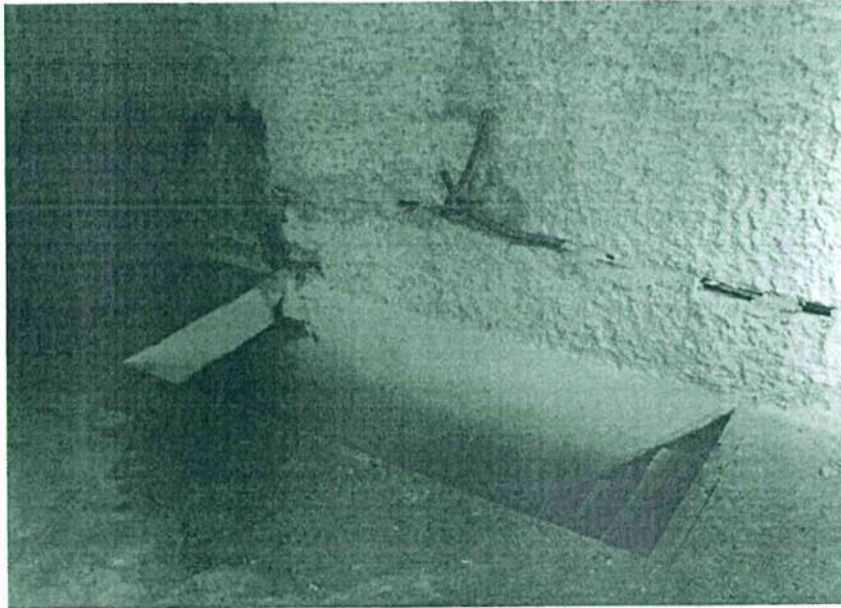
Foro nel solaio per l'accesso al piano secondo.
